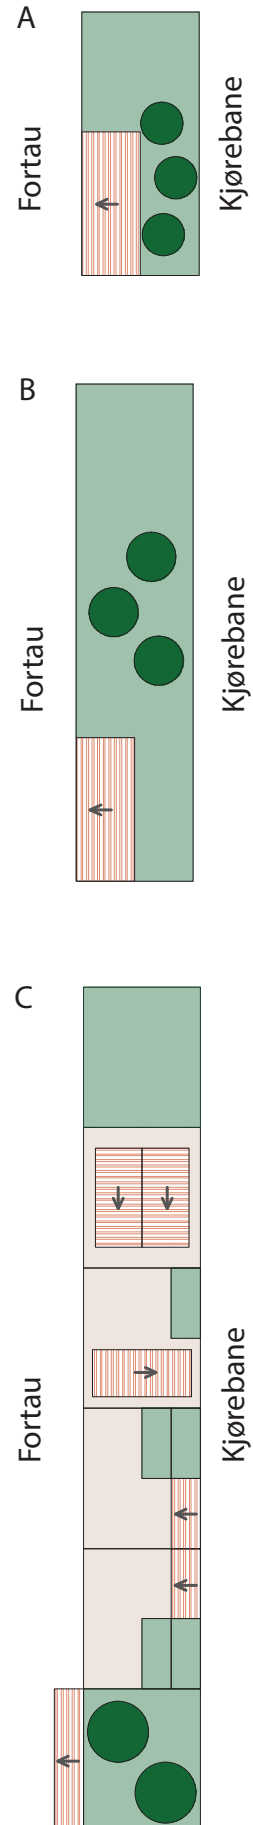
Parklet med benk der siktretningen er samme retning som kjøreretningen. Plantekassen med trær gir noe dekke i ryggen.
